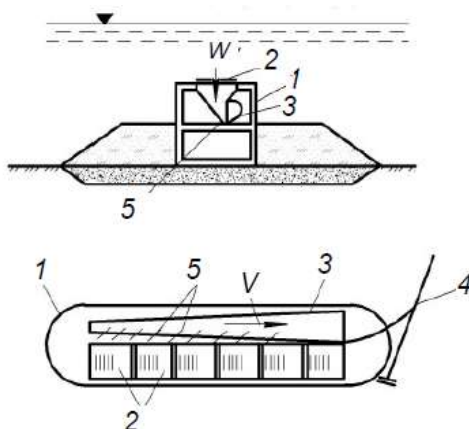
Схема оголовка з вихровою камерою і верхнім прийманням води: 1 – корпус оголовка; 2 – вікна (до 12) з решітками; 3 – сталева зварна вихрова камера (її довжина дорівнює 6-10-кратному найбільшому діаметру); 4 – самопливні лінії; 5 – струмененапрямні діафрагми у вхідній щілині камери, які спрямовують промивні струмені під кутом 45° до площини вікон
